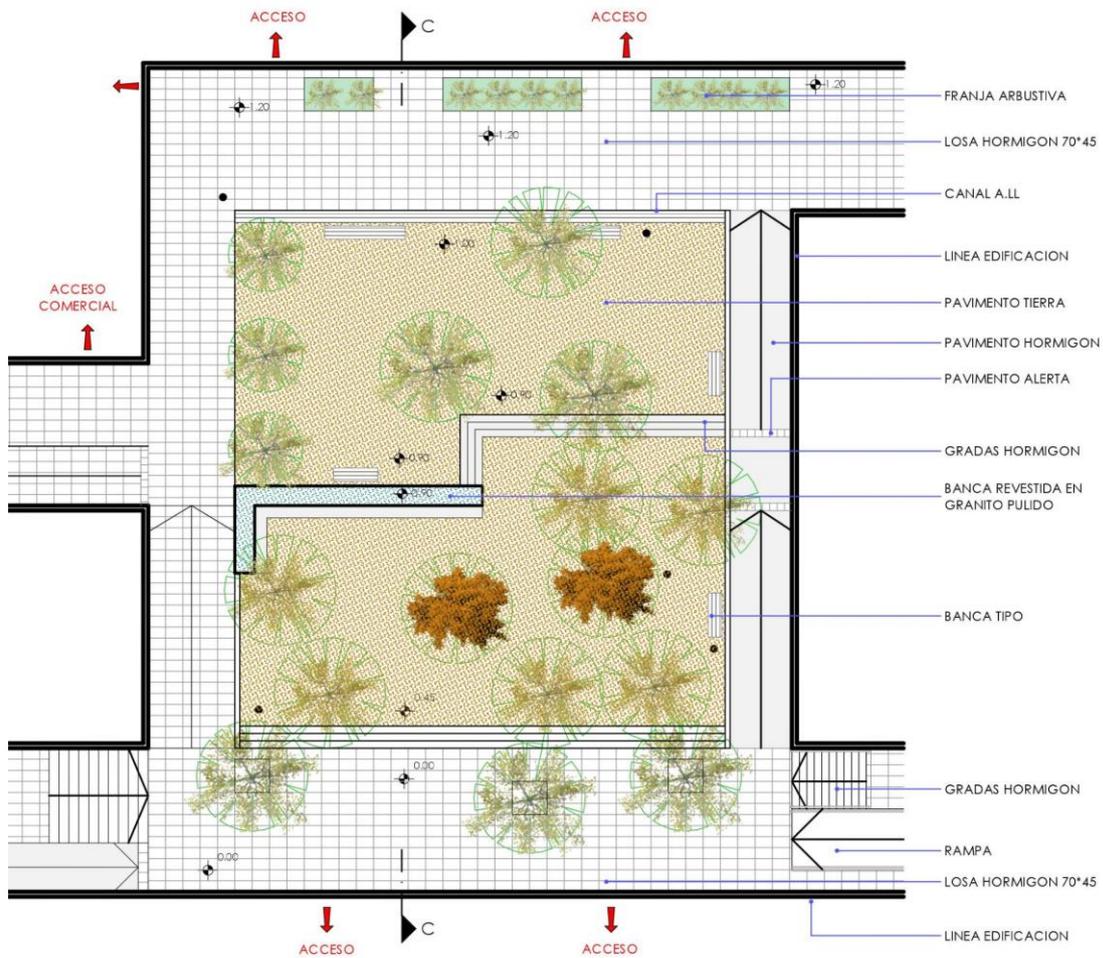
Planta y corte de solución en la intervención de las placetas que conforman los bloques L.
